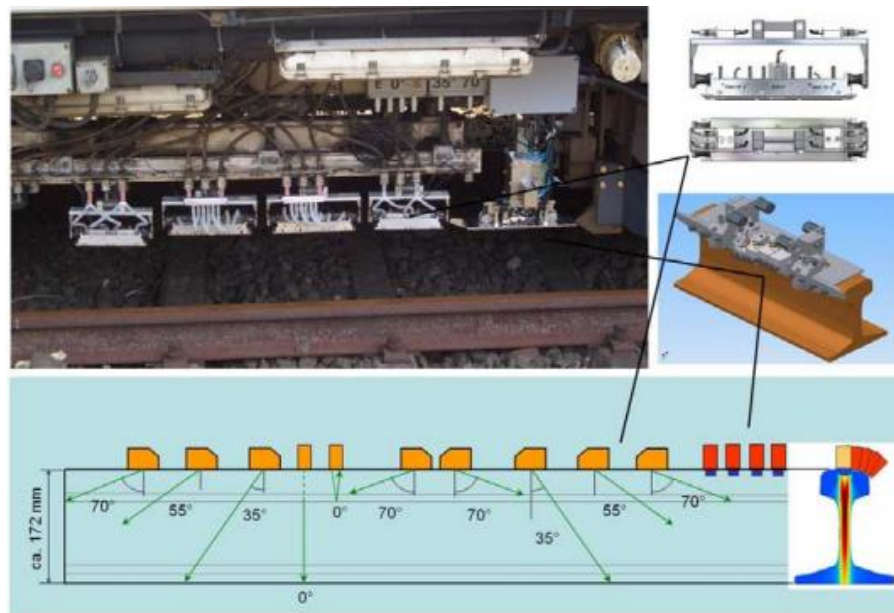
Схеми розташування датчиків для контролю рейки з поверхні кочення
